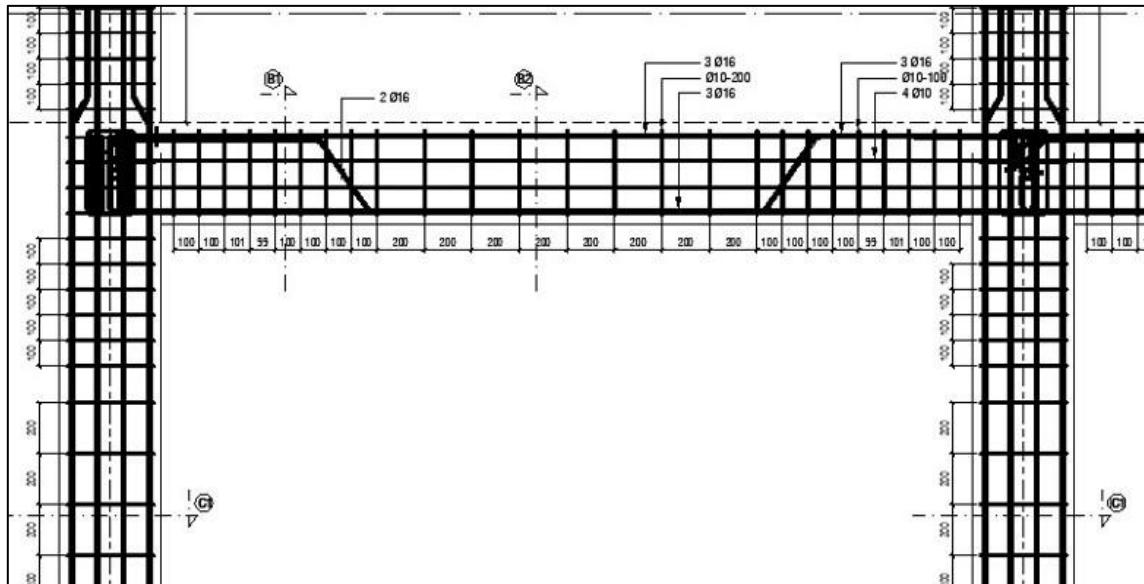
Hasil permodelan tiga dimensi struktur beton bertulang
